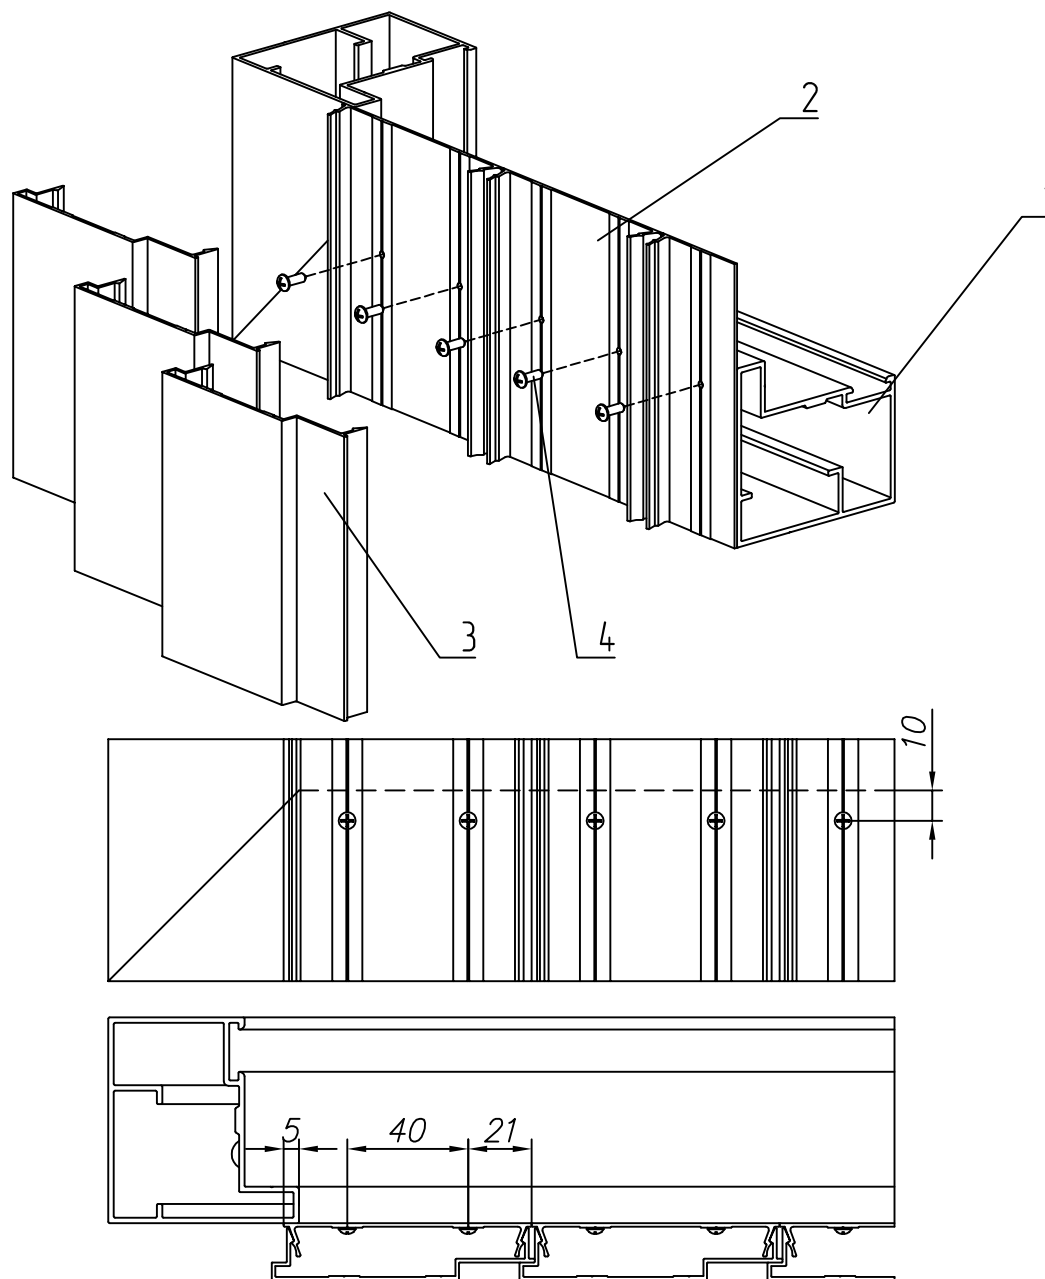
Монтаж сплошного заполнения с накладным типом монтажа:
